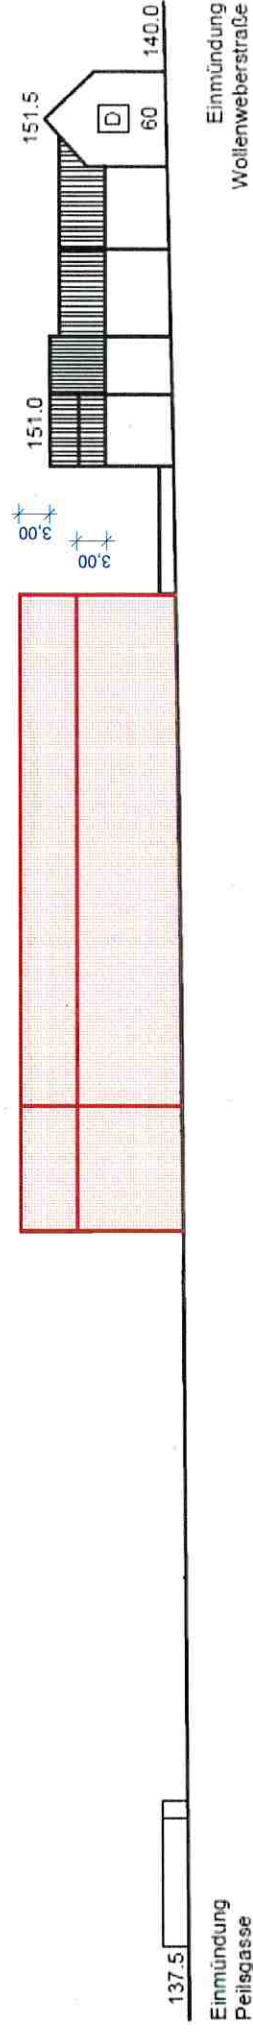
Schematische Fassadenabwicklung Dürener Str./Südseite, Höhenangaben näherungsweise in m ü NHN [Quelle: Stadt Eschweiler]
